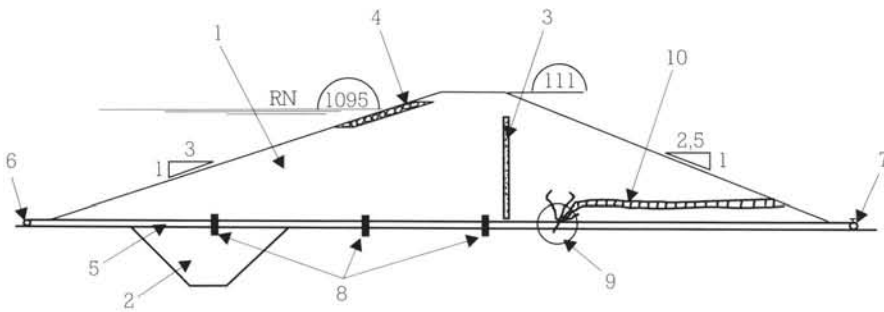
Profil type du barrage de BUGET (Haute-Garonne).
